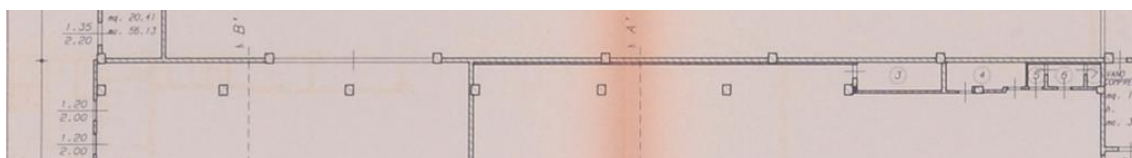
Particolare di A.1990.cap.us.T02 - Pianta piano terra - Raddoppio dei pilastri
